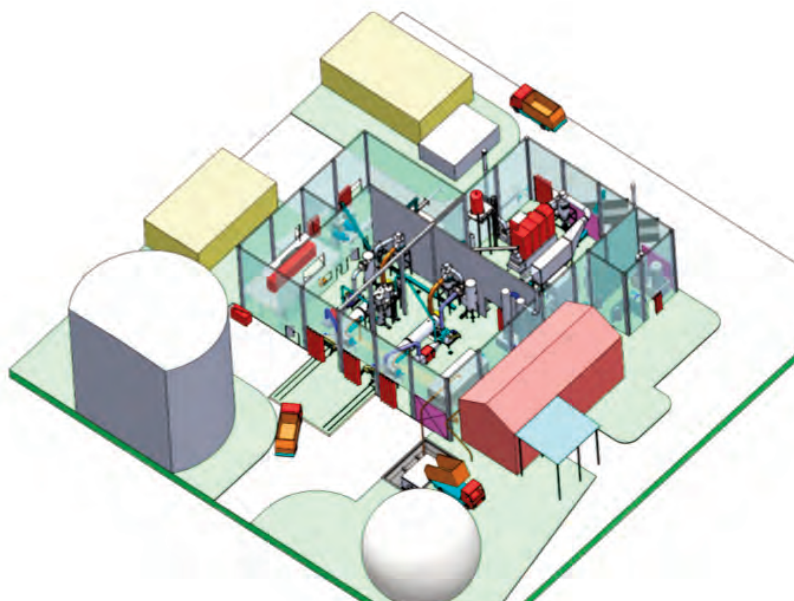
Secțiune Plan hale 3D cu amplasare echipamente / Section plan 3D halls with equipment location
